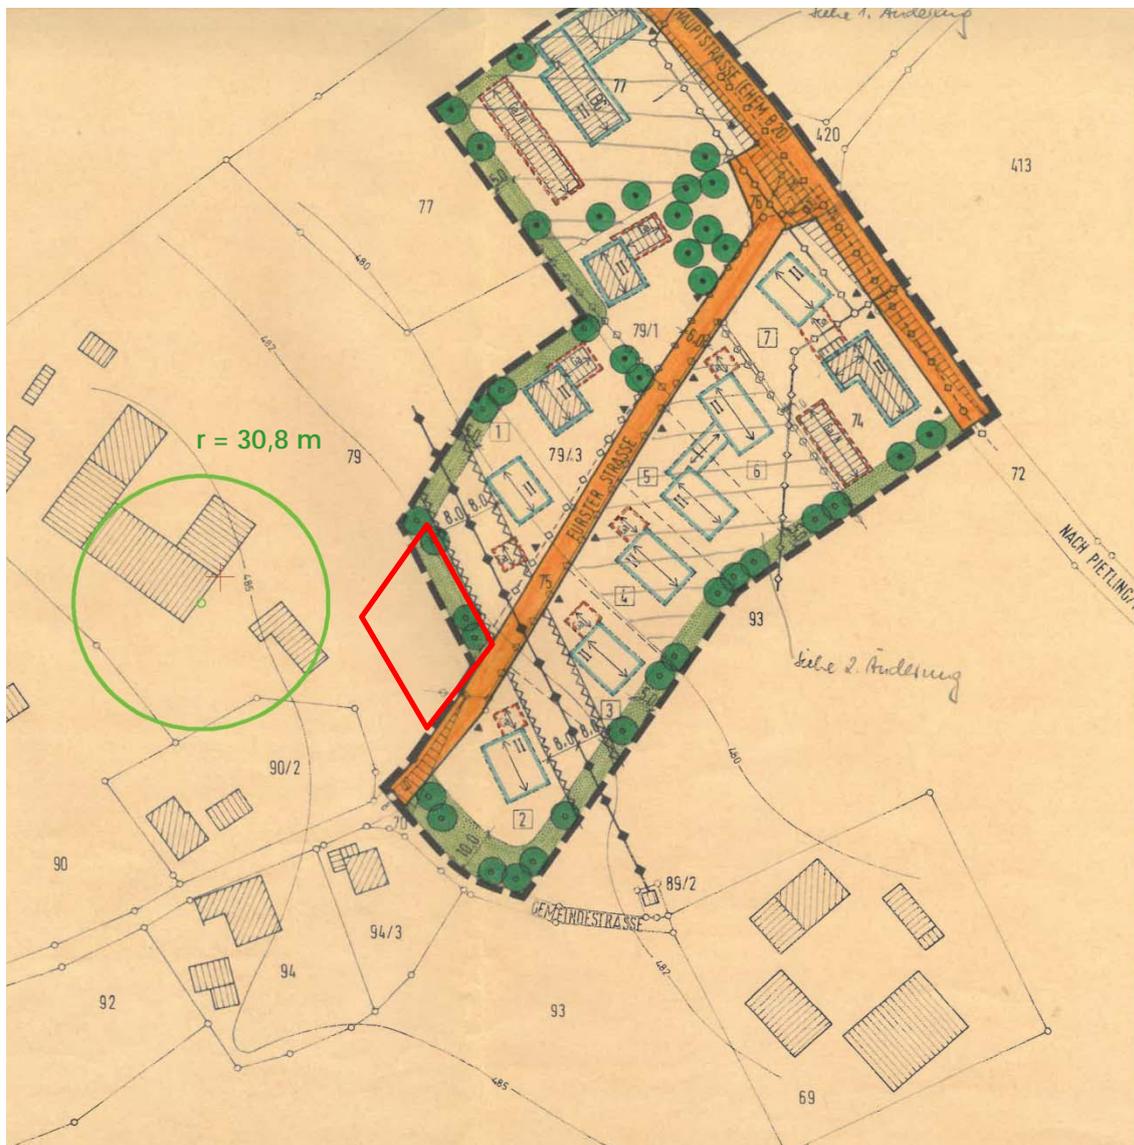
Bebauungsplan mit Darstellung des Mindestabstands Stall – Dorfgebiet
